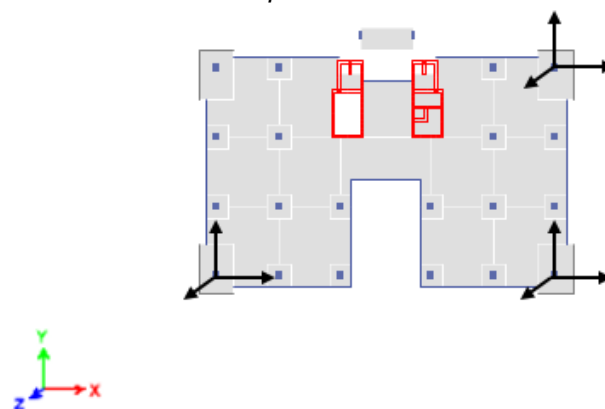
Esquema de ubicación de sensores en la Cuarta planta de la estructura. Instrumentación Tipo 3.
